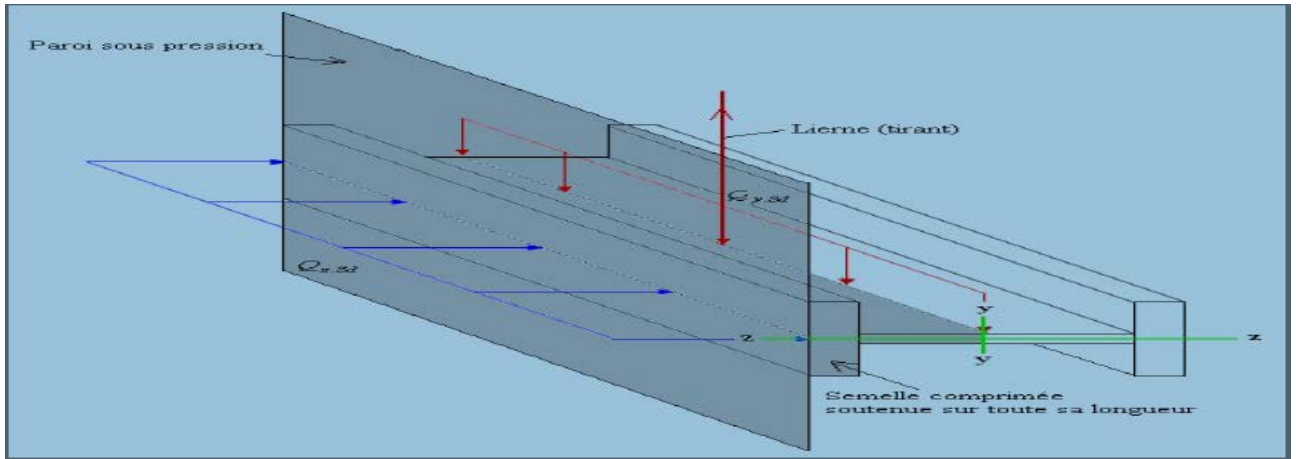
Semelle comprimée soutenue sur toute sa longueur.
